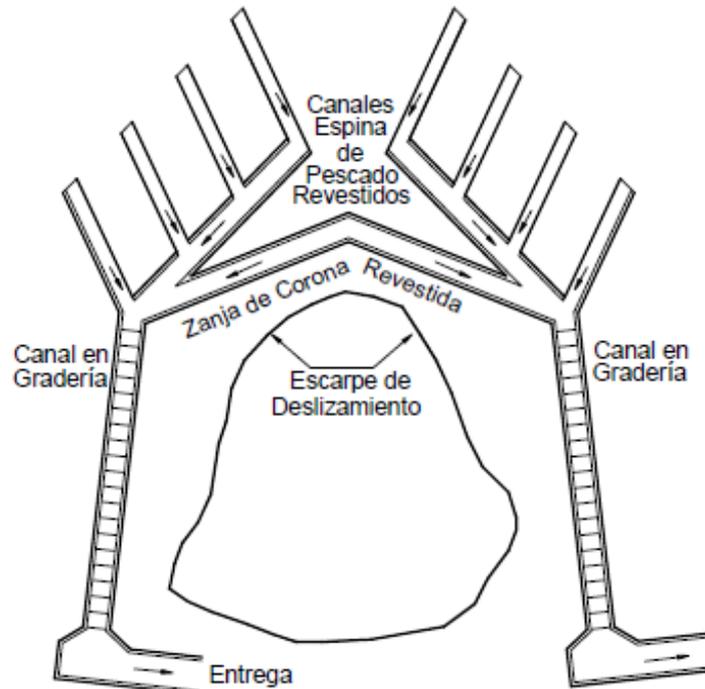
Esquema en planta de canales colectores Espina de Pescado (Suarez, 2010).
